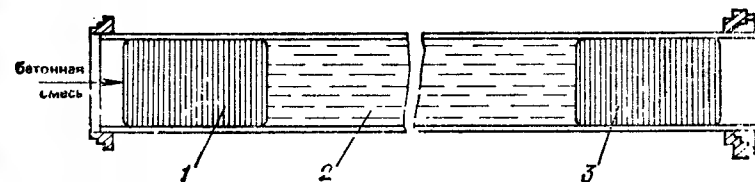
Смазка стенок бетоновода разжиженным известковым тестом перед бетонированием
